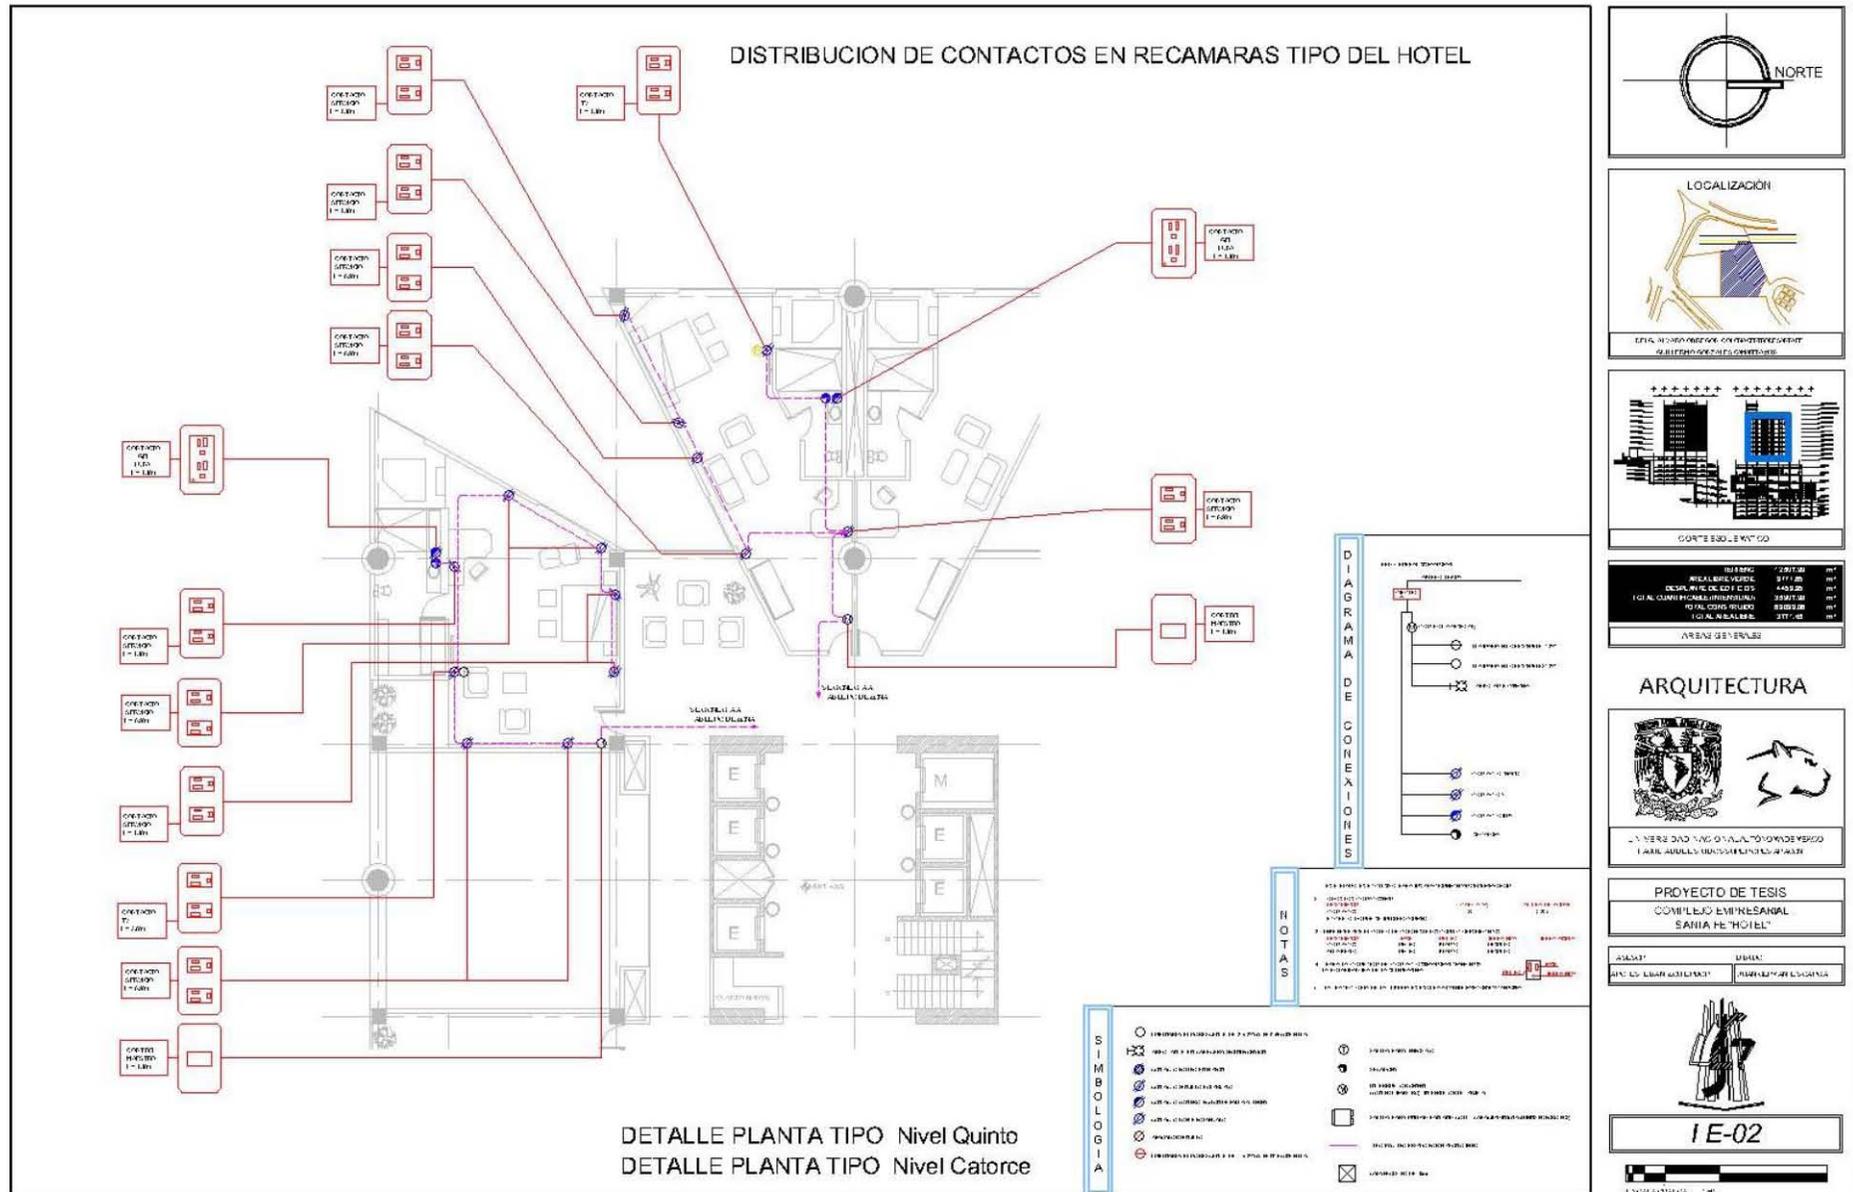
Plano IE-02; Plano distribución de contactos en recamaras tipo de hotel. Edición propia.
